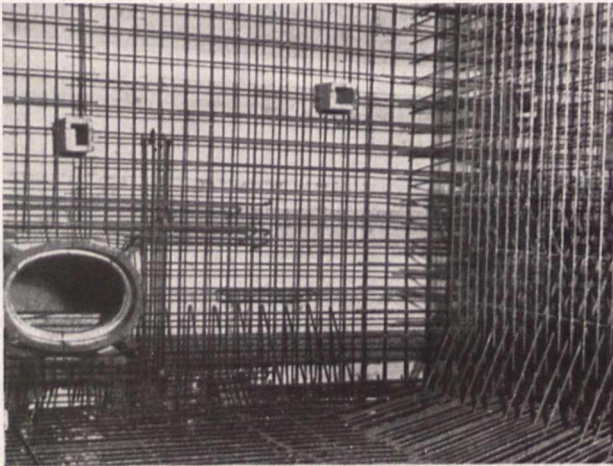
Die Wände des Gärbehälters der Brauereien sind ebenfalls mit Baustahlgewebe bewehrt
